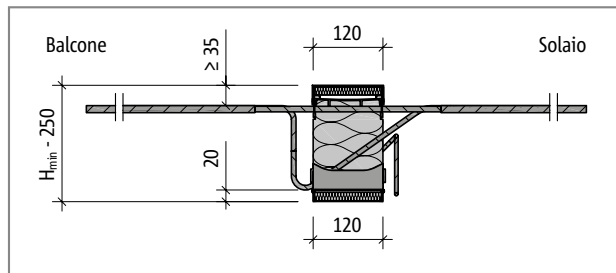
Schöck Isokorb® tipo da KXT55 a KXT100, REI120: sezione dell'elemento
